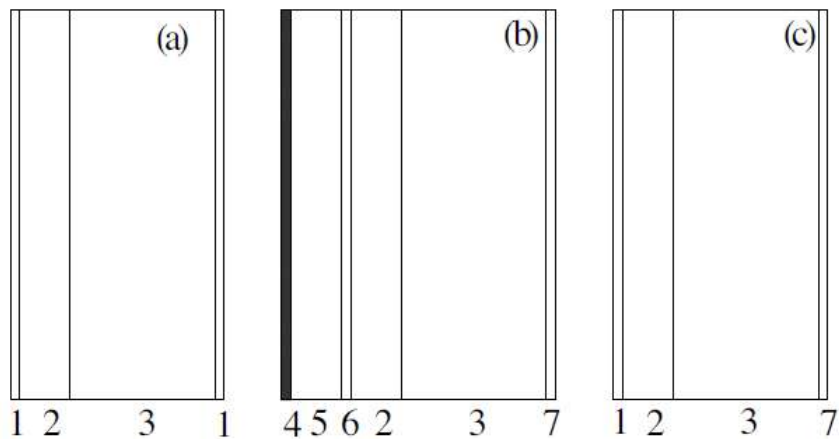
Construction des murs (a) mur de la salle ordinaire, (b) mur sud de PSPCR, (c) autres murs de PSPCR.
